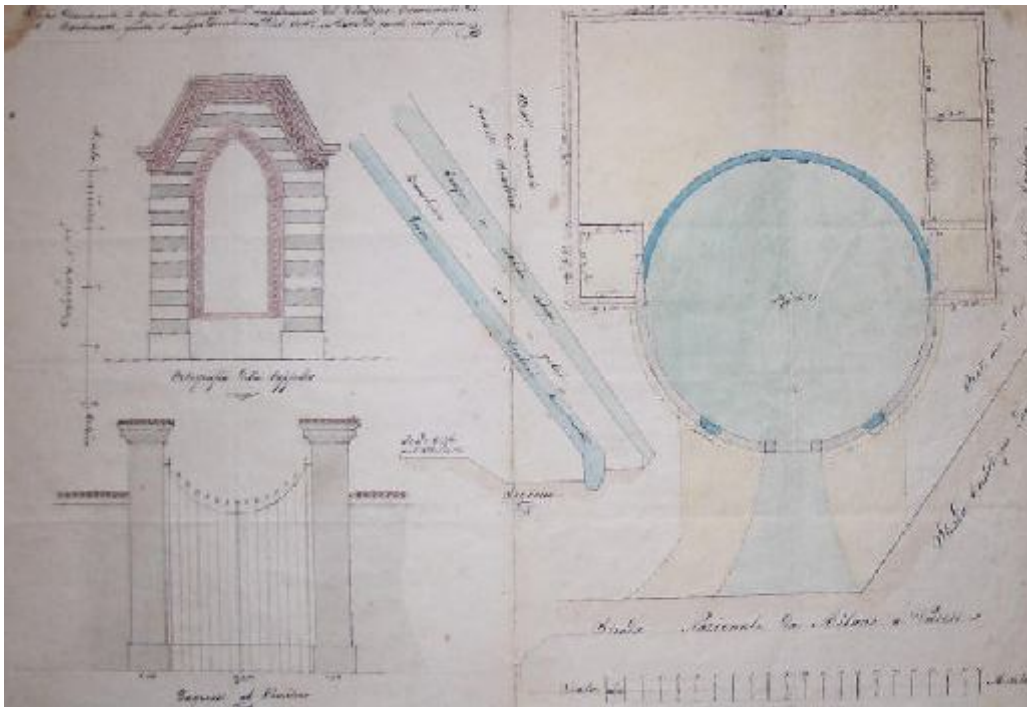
Disegni relativi a Cimiterino 1908 – prospetto della cappella, prospetto dell'ingresso, planimetria generale.
